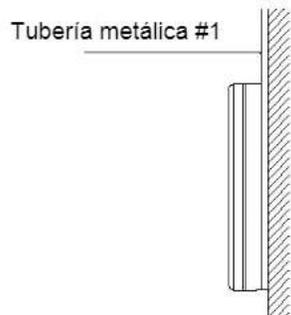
Montaje en superficie del cable Fig. 9.18 Montaje empataado del cable
